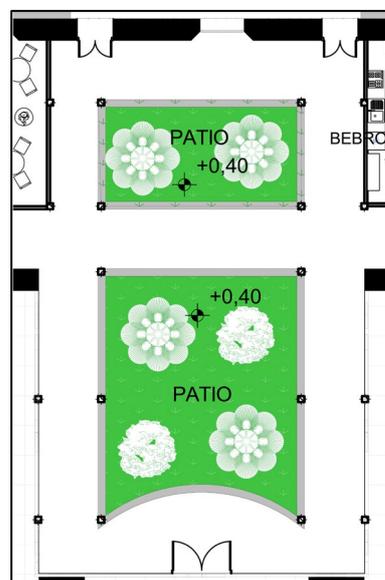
Trame structurelle. Patio Crèche multi-accueil (RDC).
